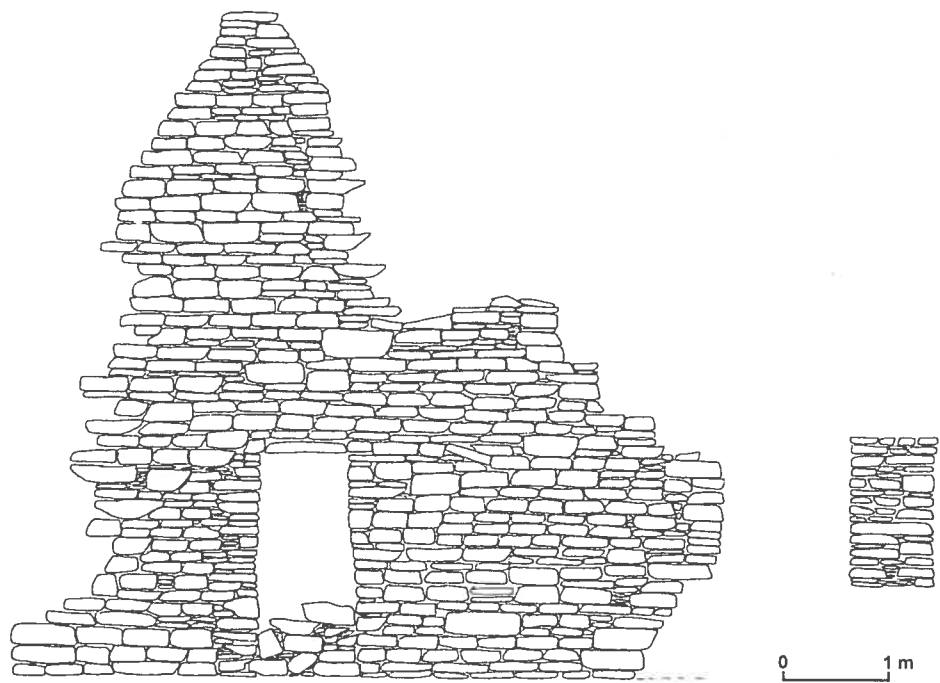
Façade externe en pignon d'une construction rectangulaire, et profil de l'entrée, forêt d'eucalyptus, Rapayan.
